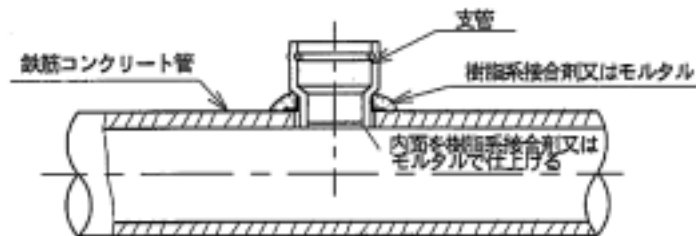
鉄筋コンクリート本管に対する支管の接合
